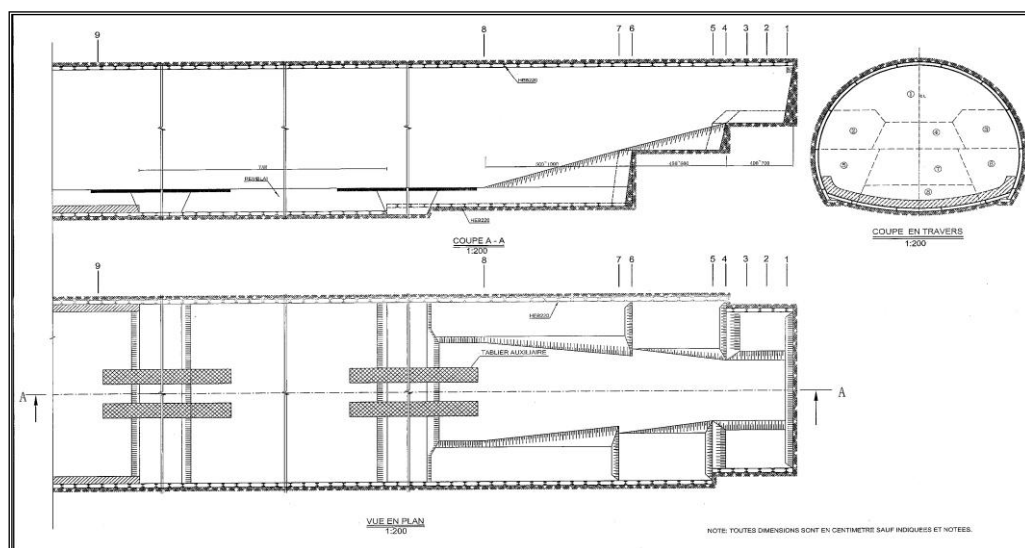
Vue en plan et en coupes longitudinale et transversale des différentes phases d'excavation en section divisée
